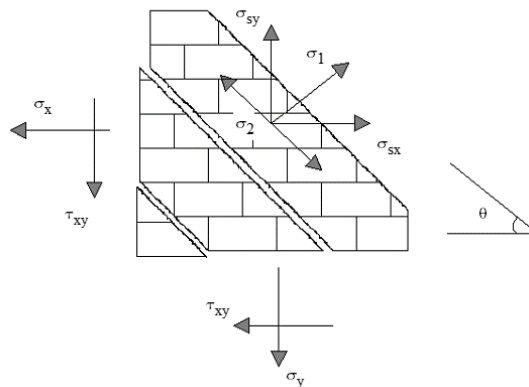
Estado de esfuerzos en un puntal de compresión del macroelemento de mampostería
